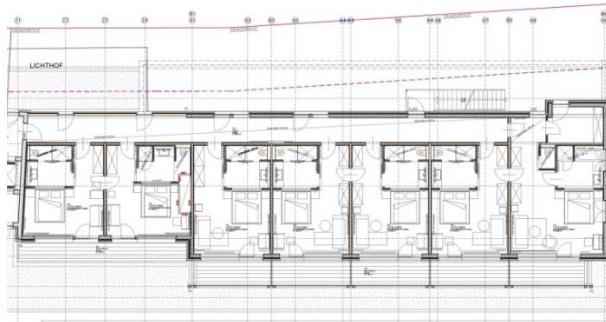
Grundriss Hotel Bauernhofer
